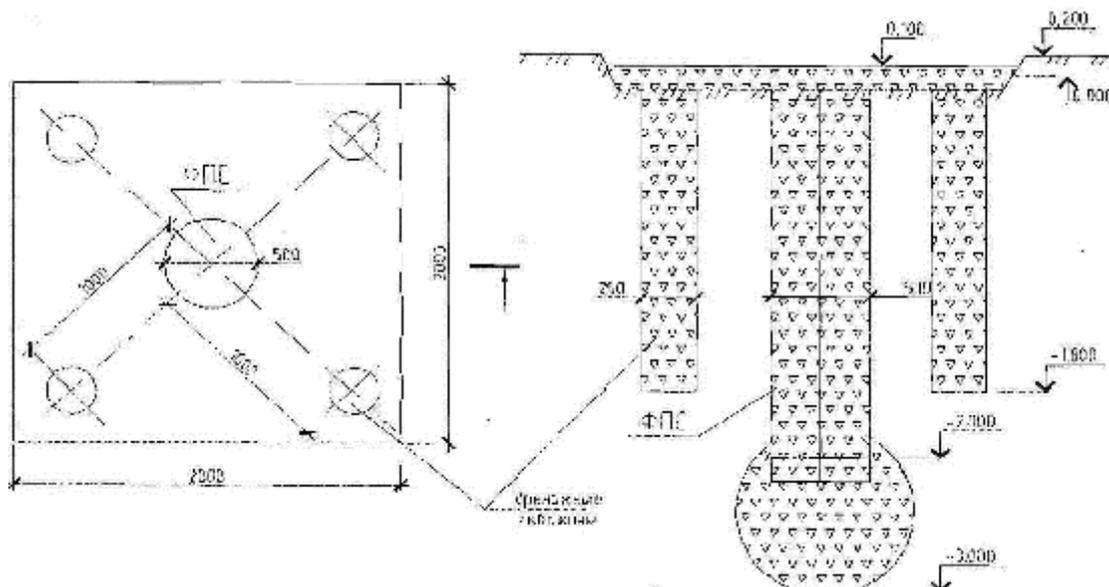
Схема расположения выработок для локального замачивания грунта в основании сваи
